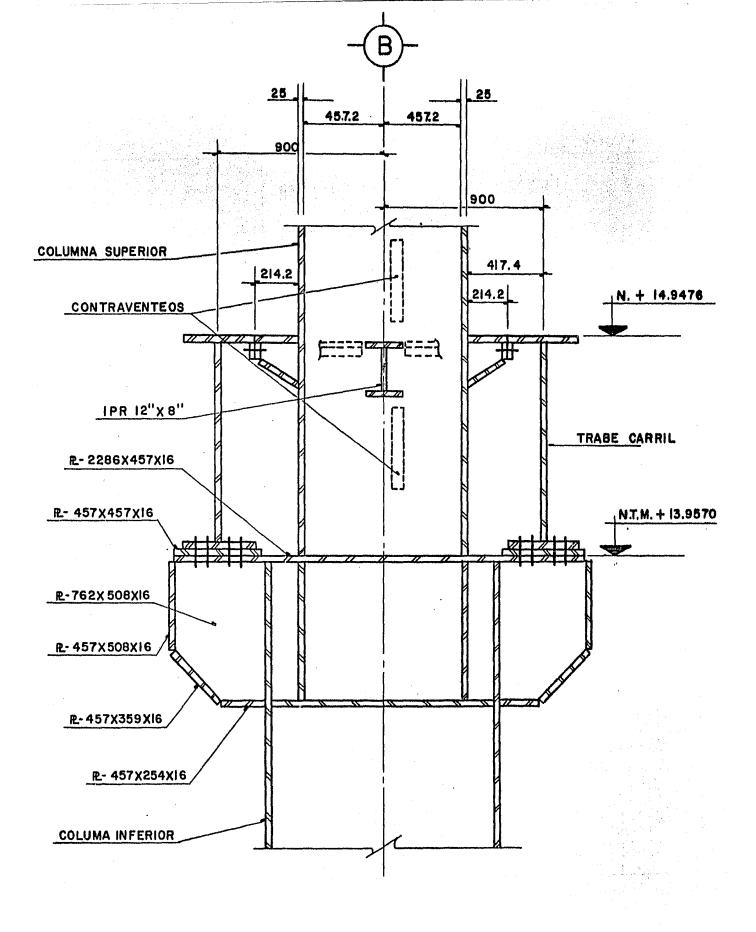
COLUMNA CENTRAL. EJE "B"
